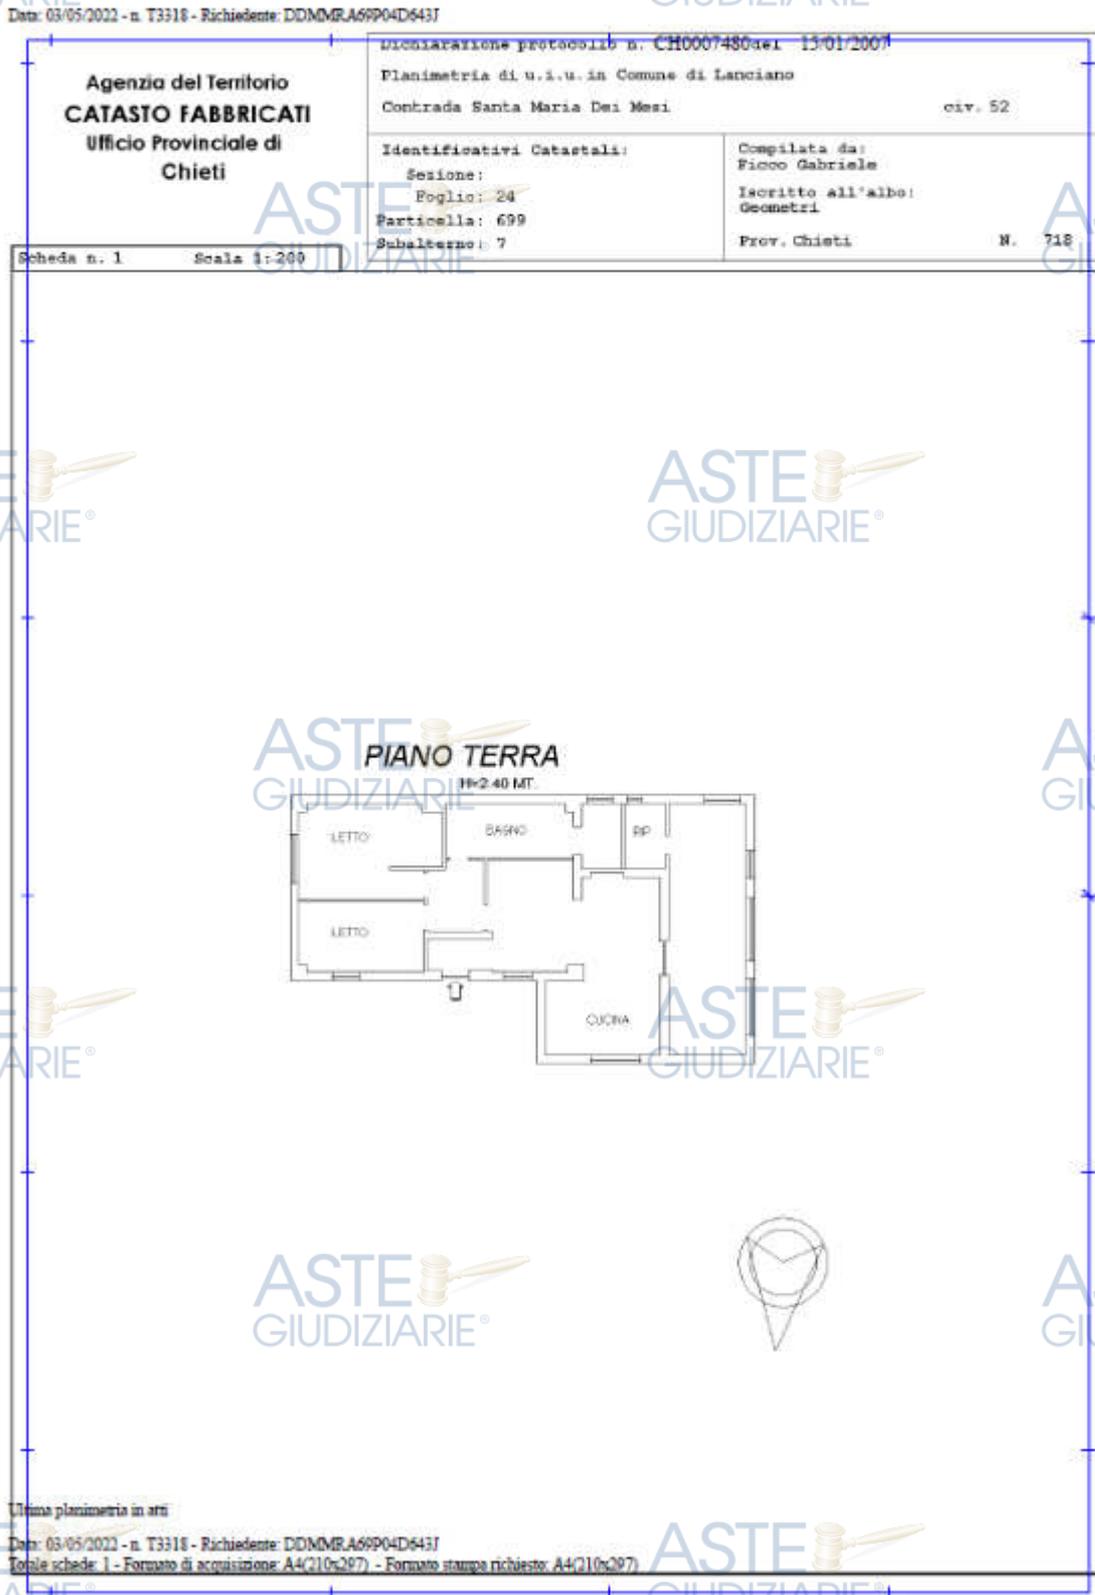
Stralcio della Planimetria Catastale Foglio 24 P.IIa 699 sub 8---
